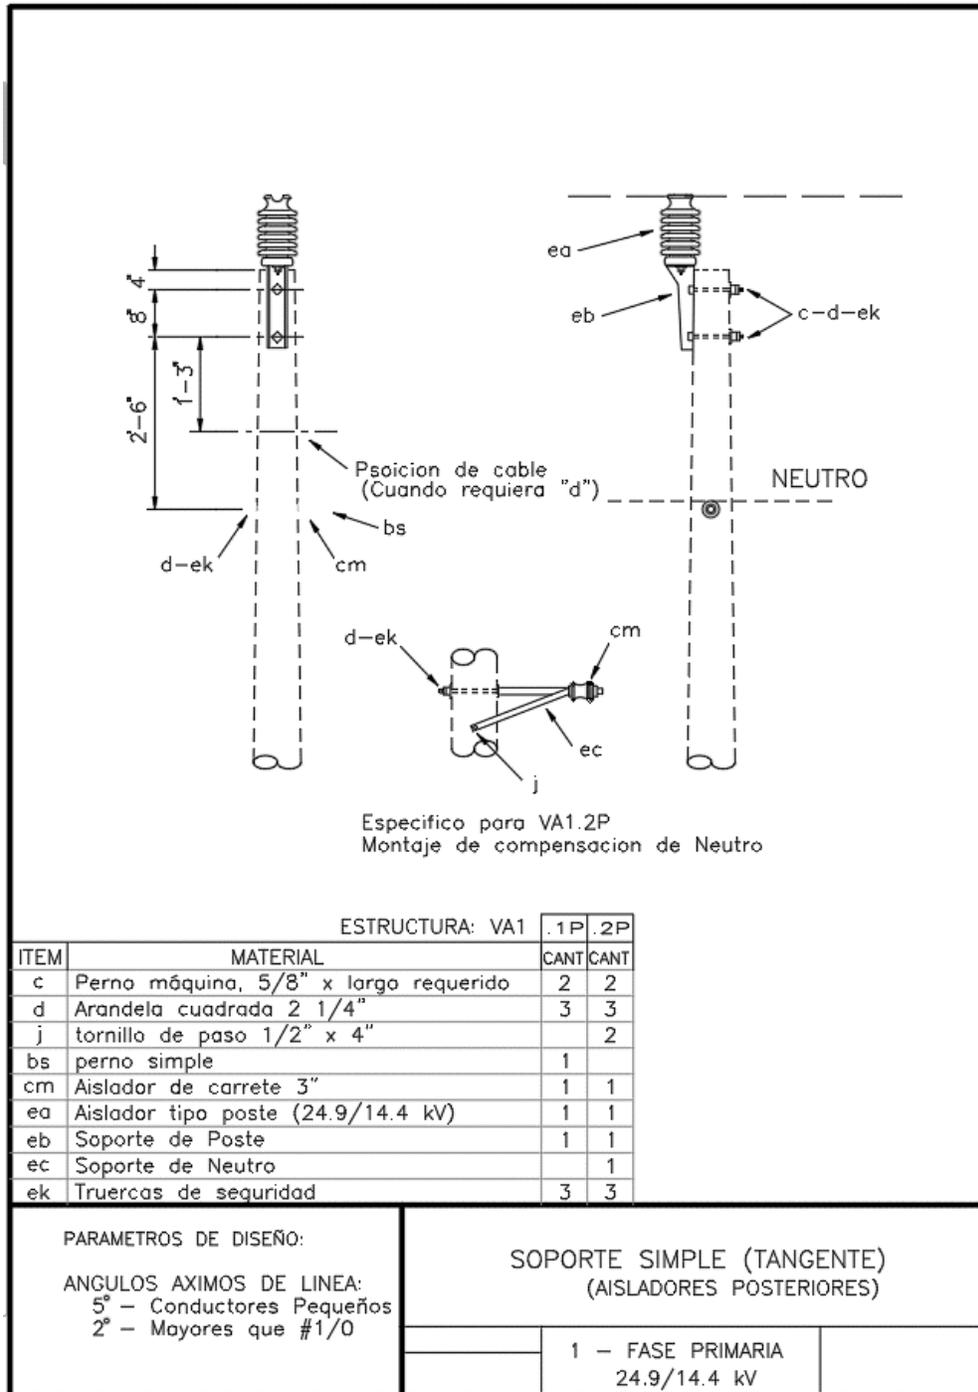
Diseño de construcción para la estructura denominada "Tangente sencilla una fase".
